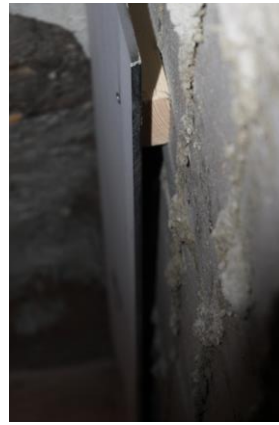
houtbetonplaat op een panlat, zodat ruimte ontstaat om weg te kruipen, toegepast in vleermuisverblijf Oisterwijk
